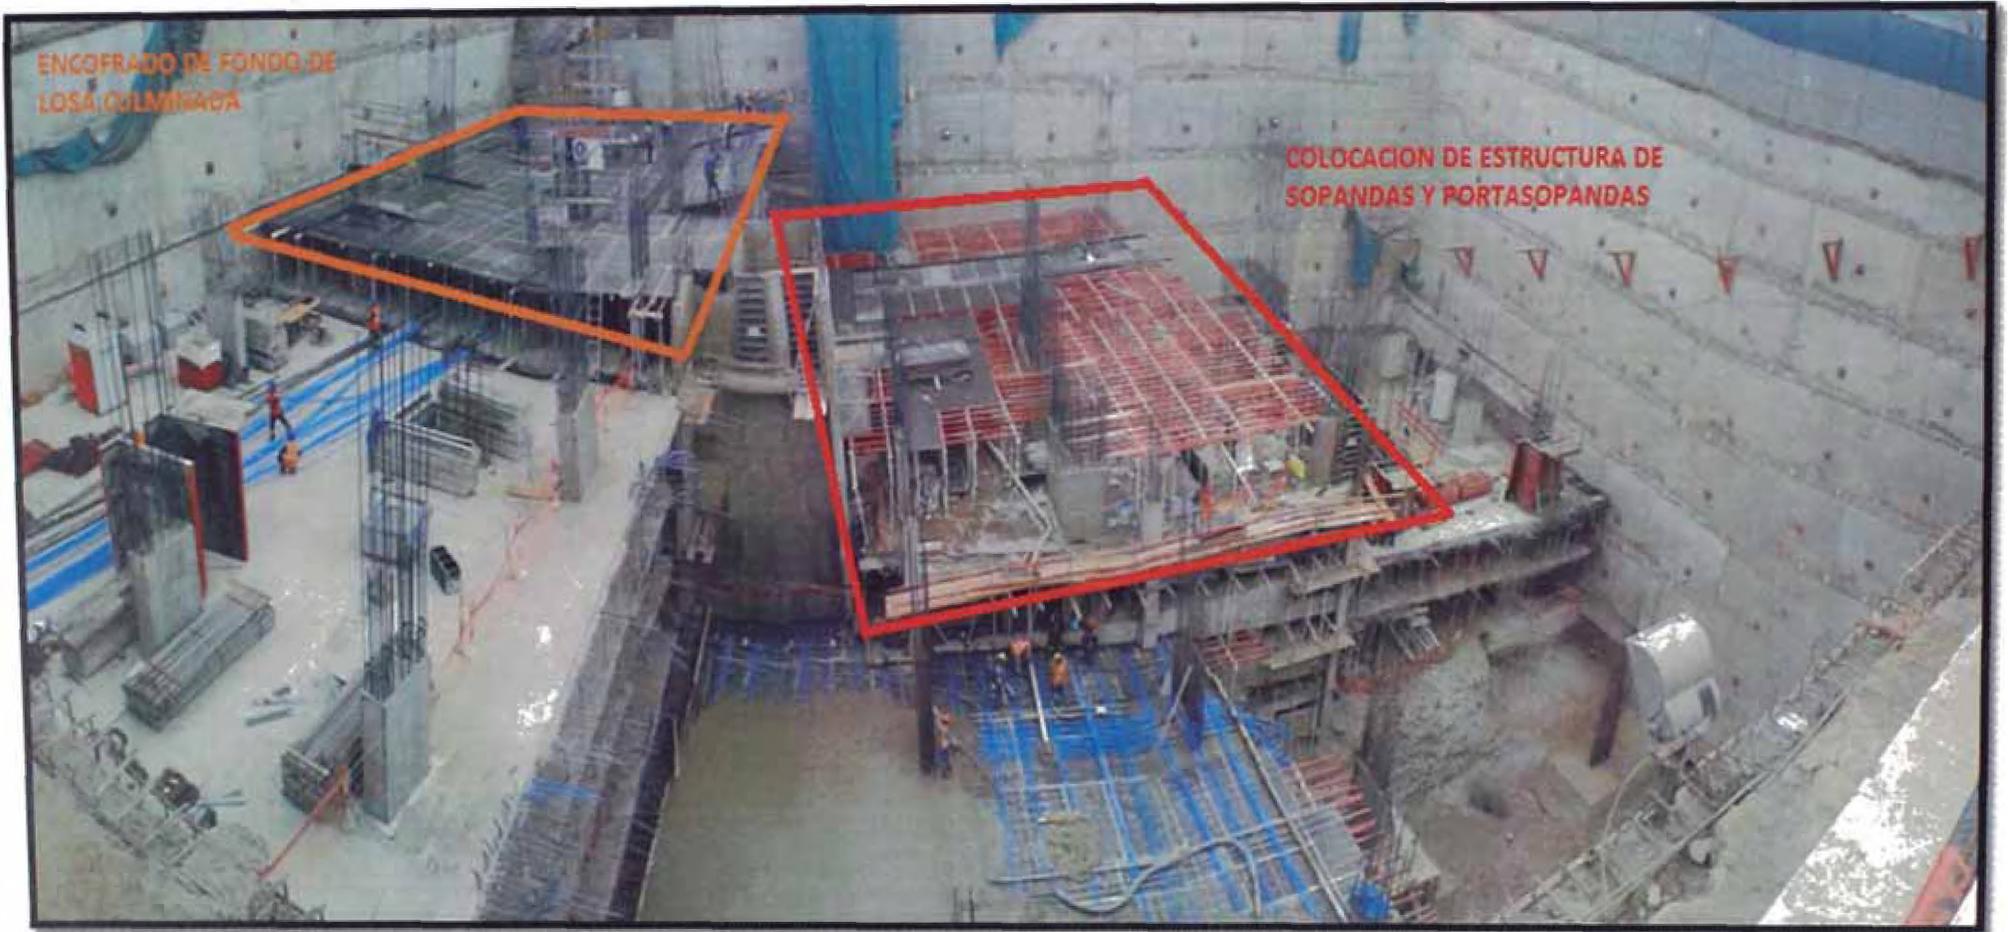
Encofrado de fondo de losa ejecutado en el proyecto.
